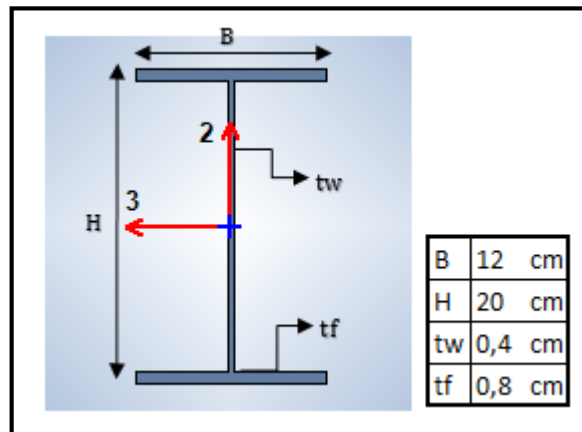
Dimensiones de Viga secundaria 2 con pórticos arriostrados.
